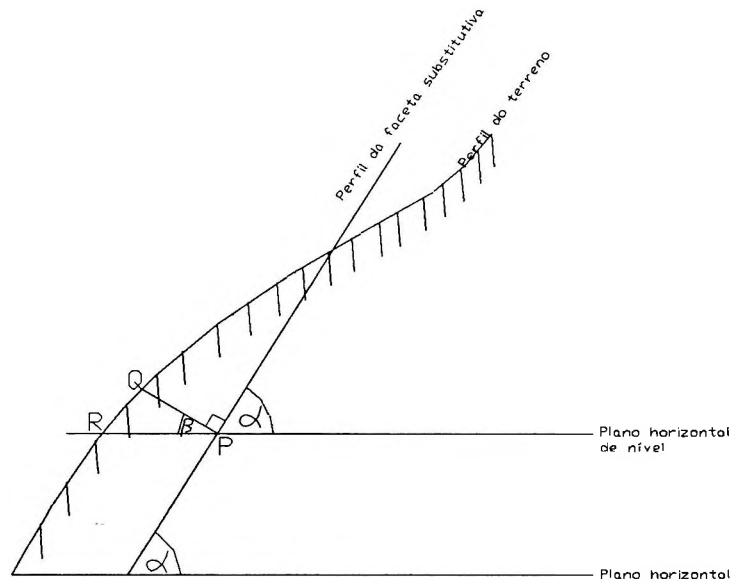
Perfil do terreno e Perfil da face substitutiva.
